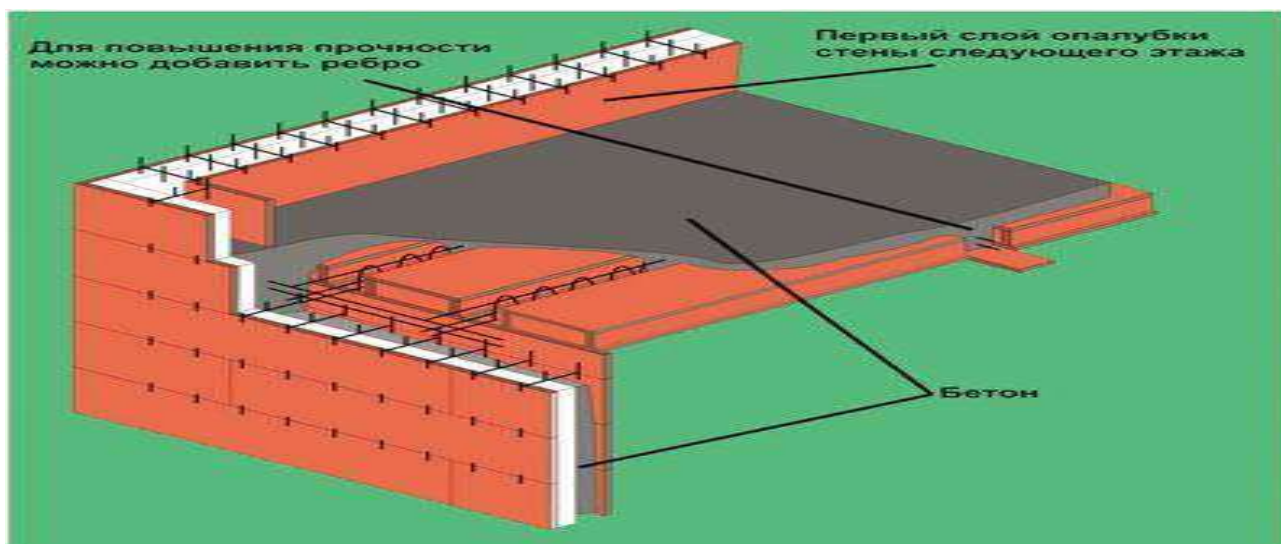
конструкций, внутри закладывают строительную арматуру с рифлениями и заливают бетон. Как правило, при использовании несъемной опалубки не требуется сложной строительной техники [24, 25].
